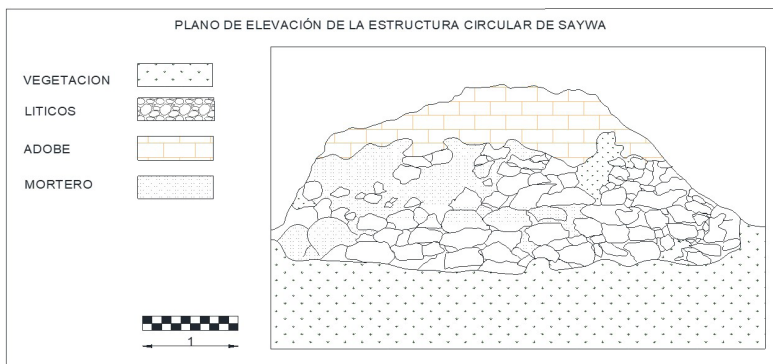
Dibujo de elevación de muro exterior de la estructura circular N° 40.
